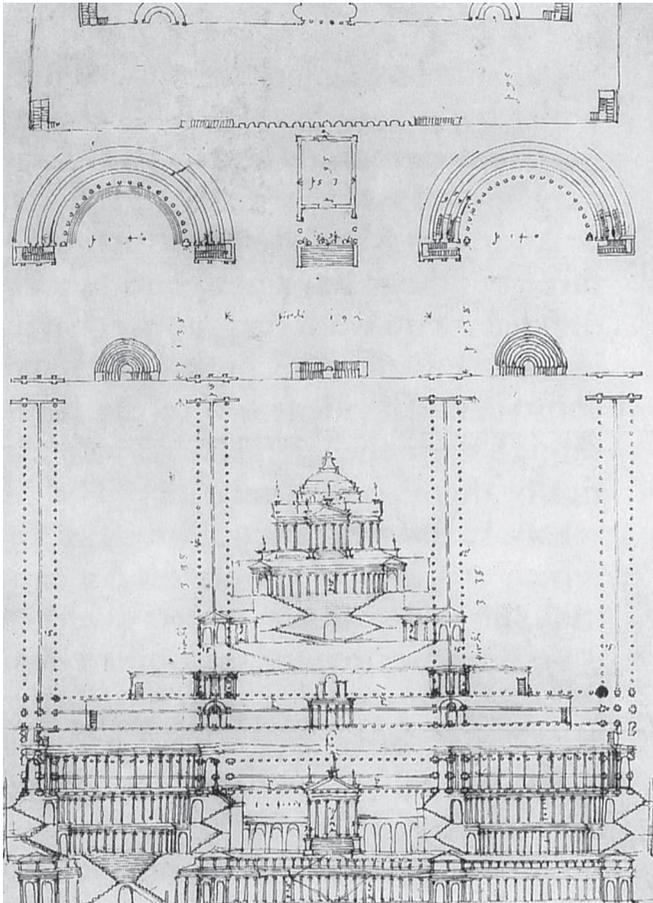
Planta y fachada frontal de la Reconstrucción del Templo della Fortuna Primigenia de Andrea Palladio, 1560 (Fuente: Robert Tavernor, 1980: 76).
